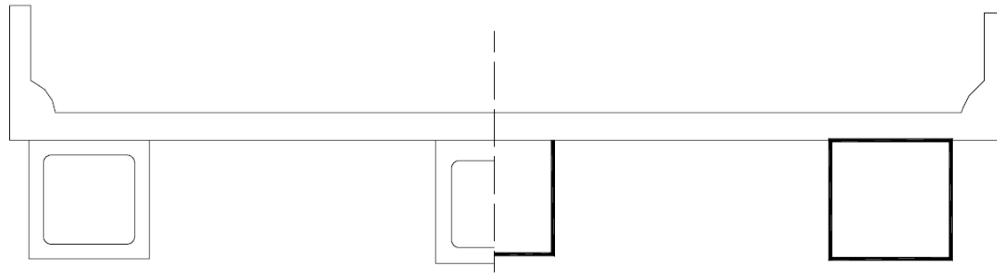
Sección transversal de puente con vigas cajón cerradas de acero o concreto reforzado prefabricado (AASHTO, 2007).
